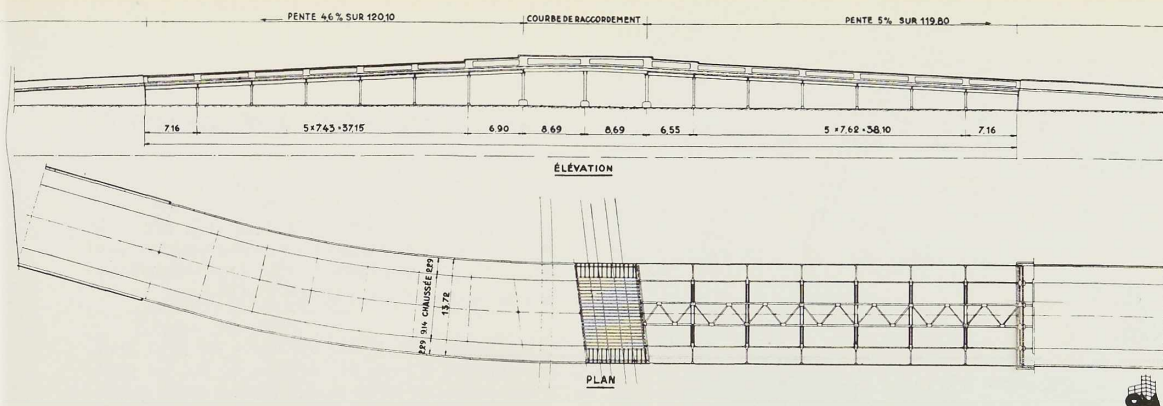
Elévation et vue en plan d'un passage supérieur remplaçant un passage à niveau.
